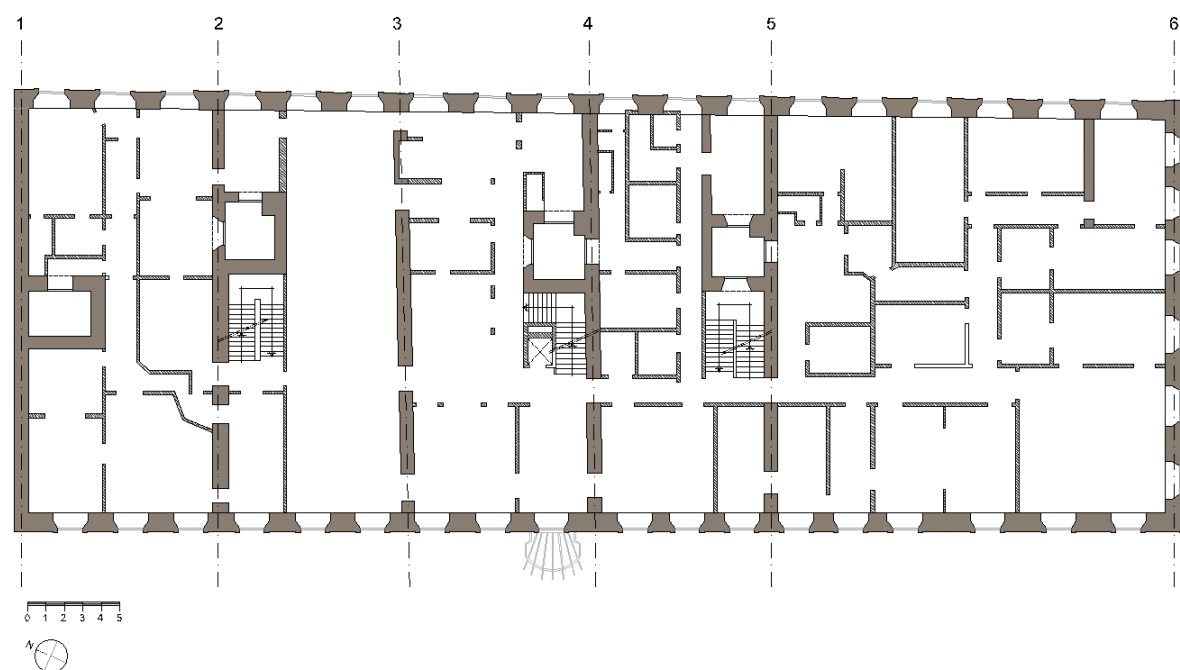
Planta do Piso 1 – (Levantamento do Existente)
